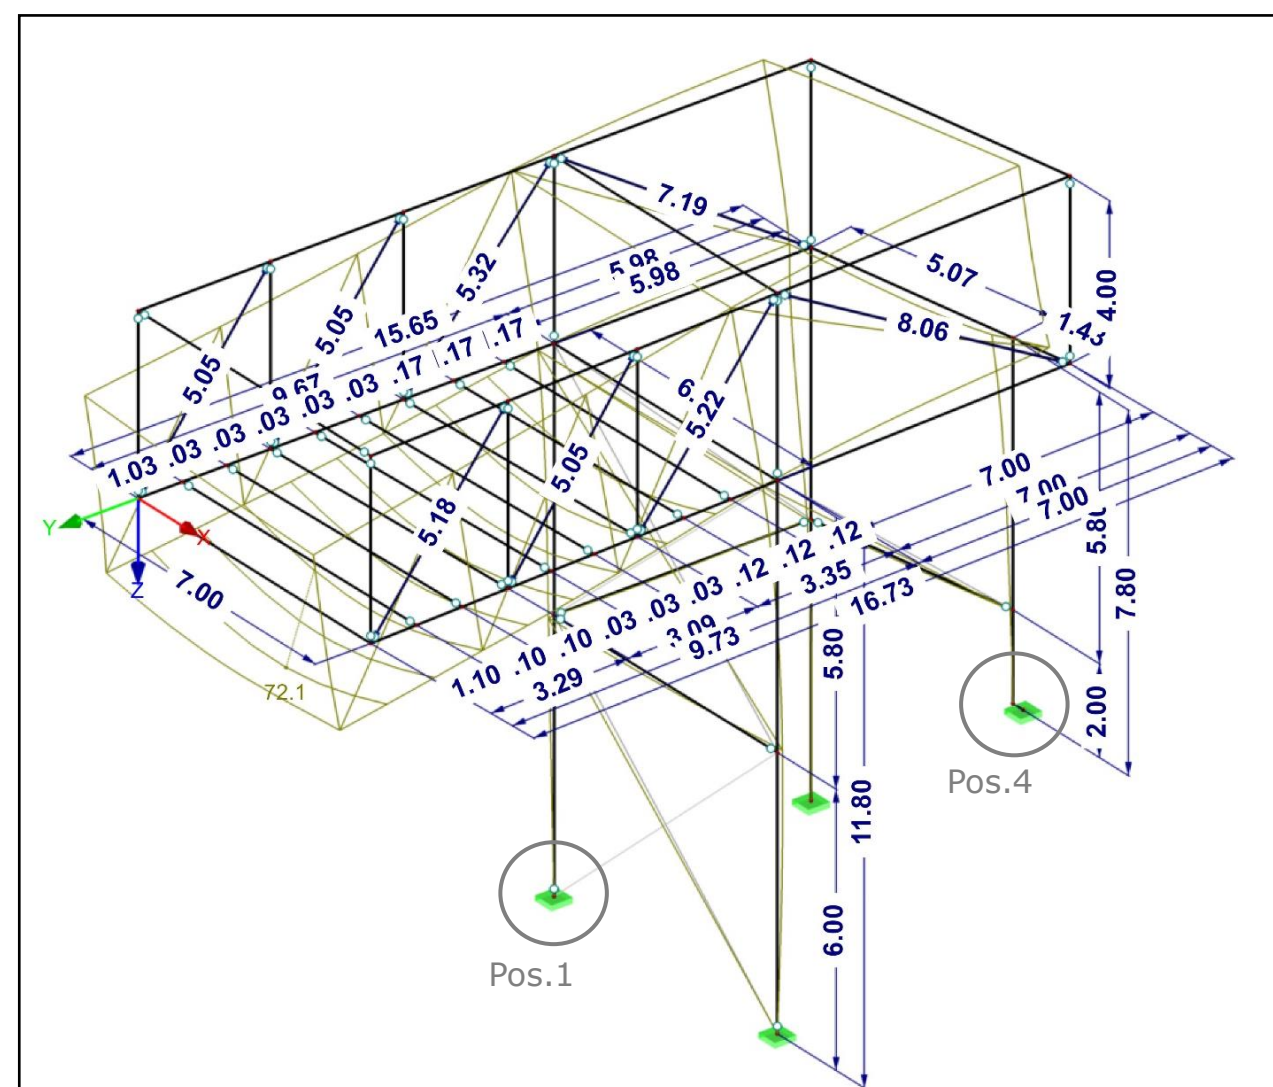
RSTAB-Modell der temporären Stahlfachwerkkonstruktion im Bauzustand
